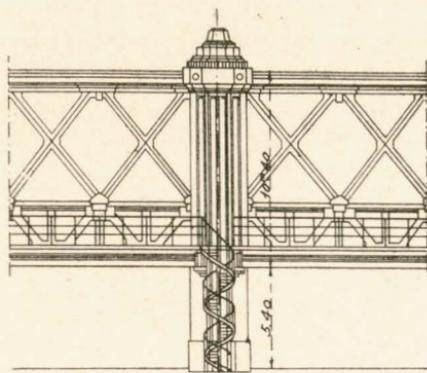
Punto de apoyo del puente de la calle de Lafayette (París).
